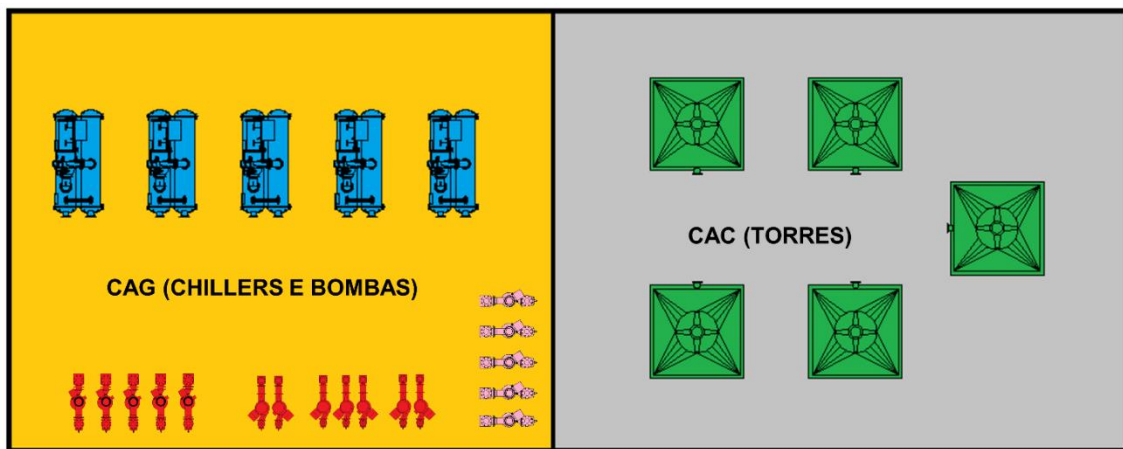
Compatibilização – Planta do 2º Subsolo e localização sugerida para CAG e CAC
